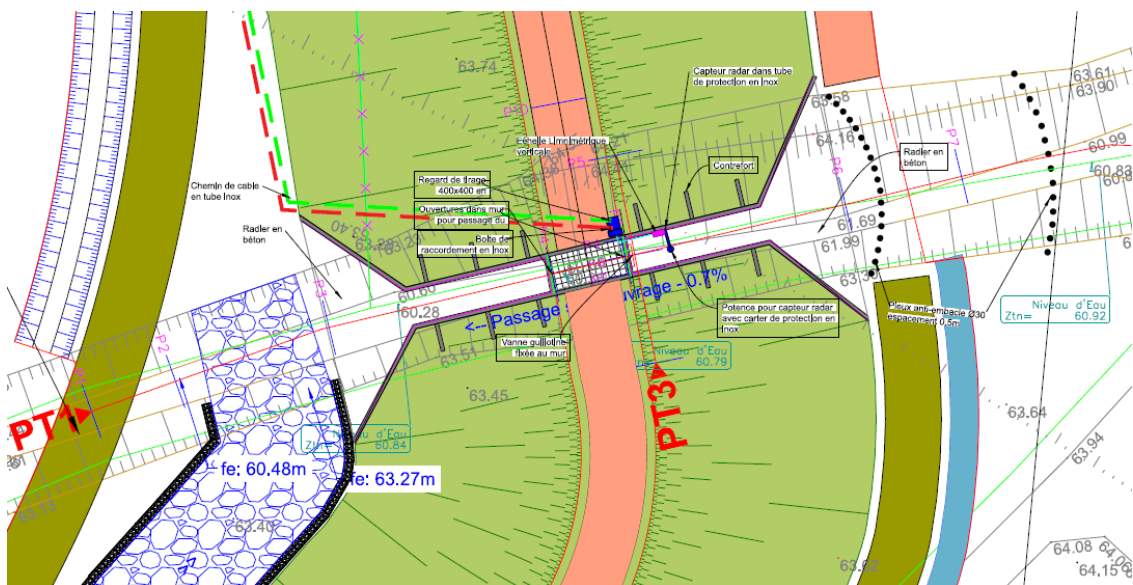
Dispositif de franchissement de la digue - vue en plan
